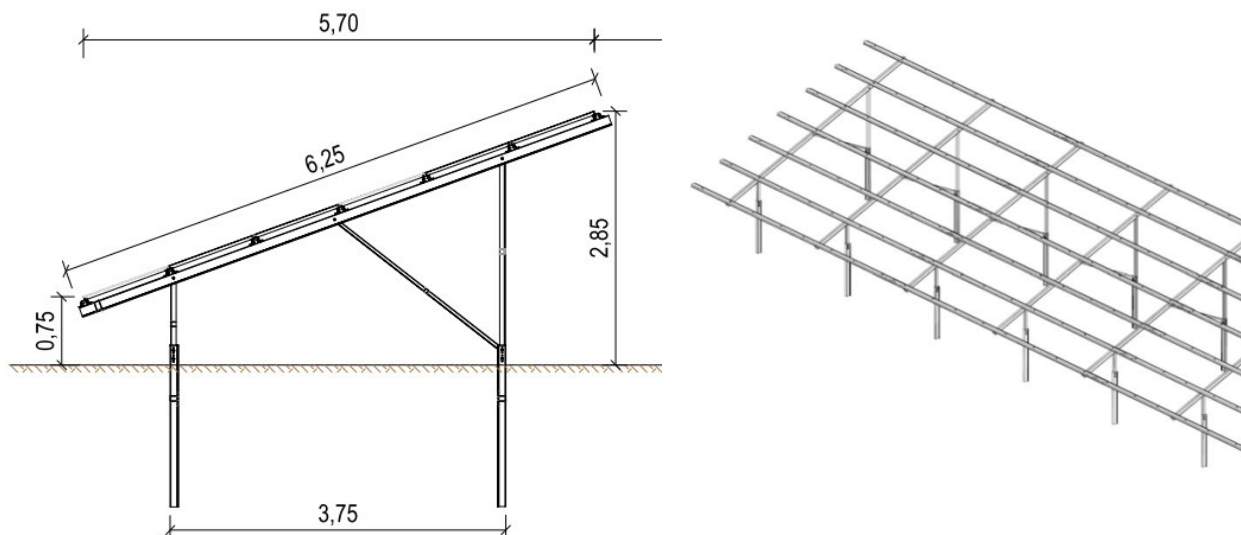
Skizze der Modulkonstruktion (Quelle: Planungsunterlagen)
